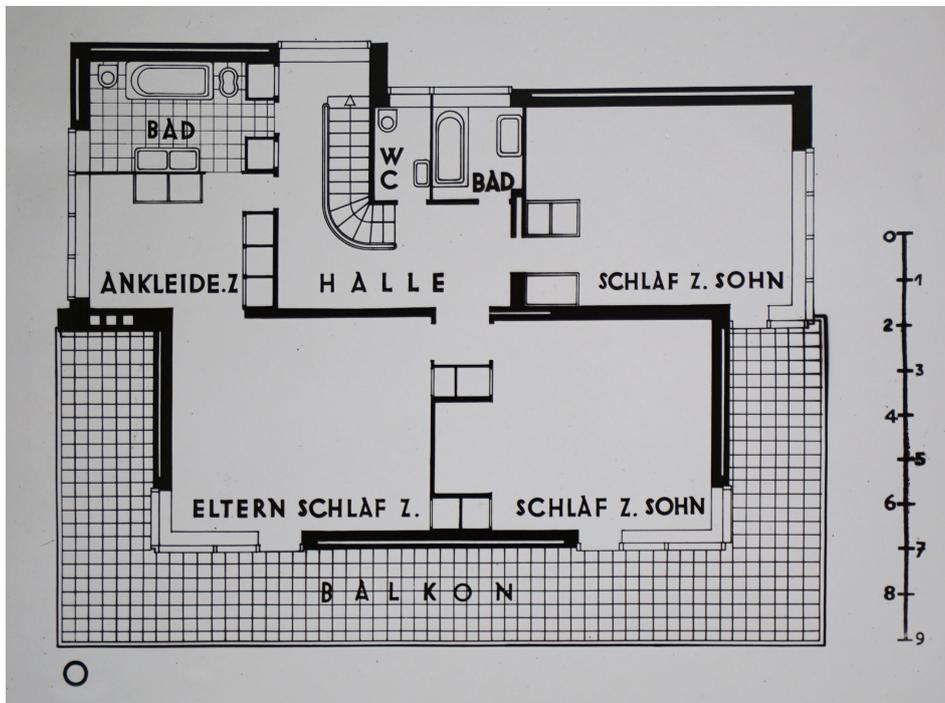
Grundriss 1. Obergeschoss, Publikationsplan, ohne Datum
